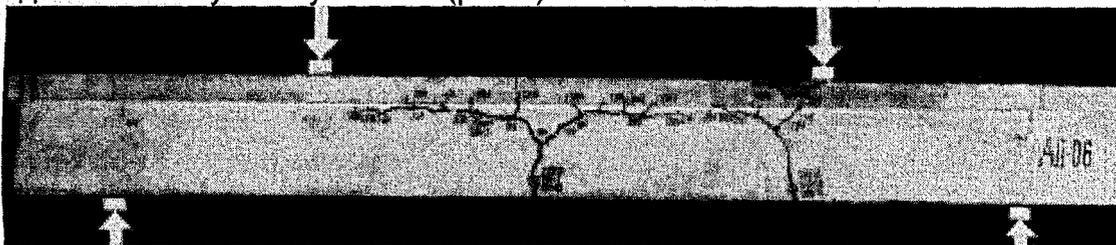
Характер трещинообразования и разрушения балки армированной предварительно напряжённой арматурой без сцепления с бетоном
